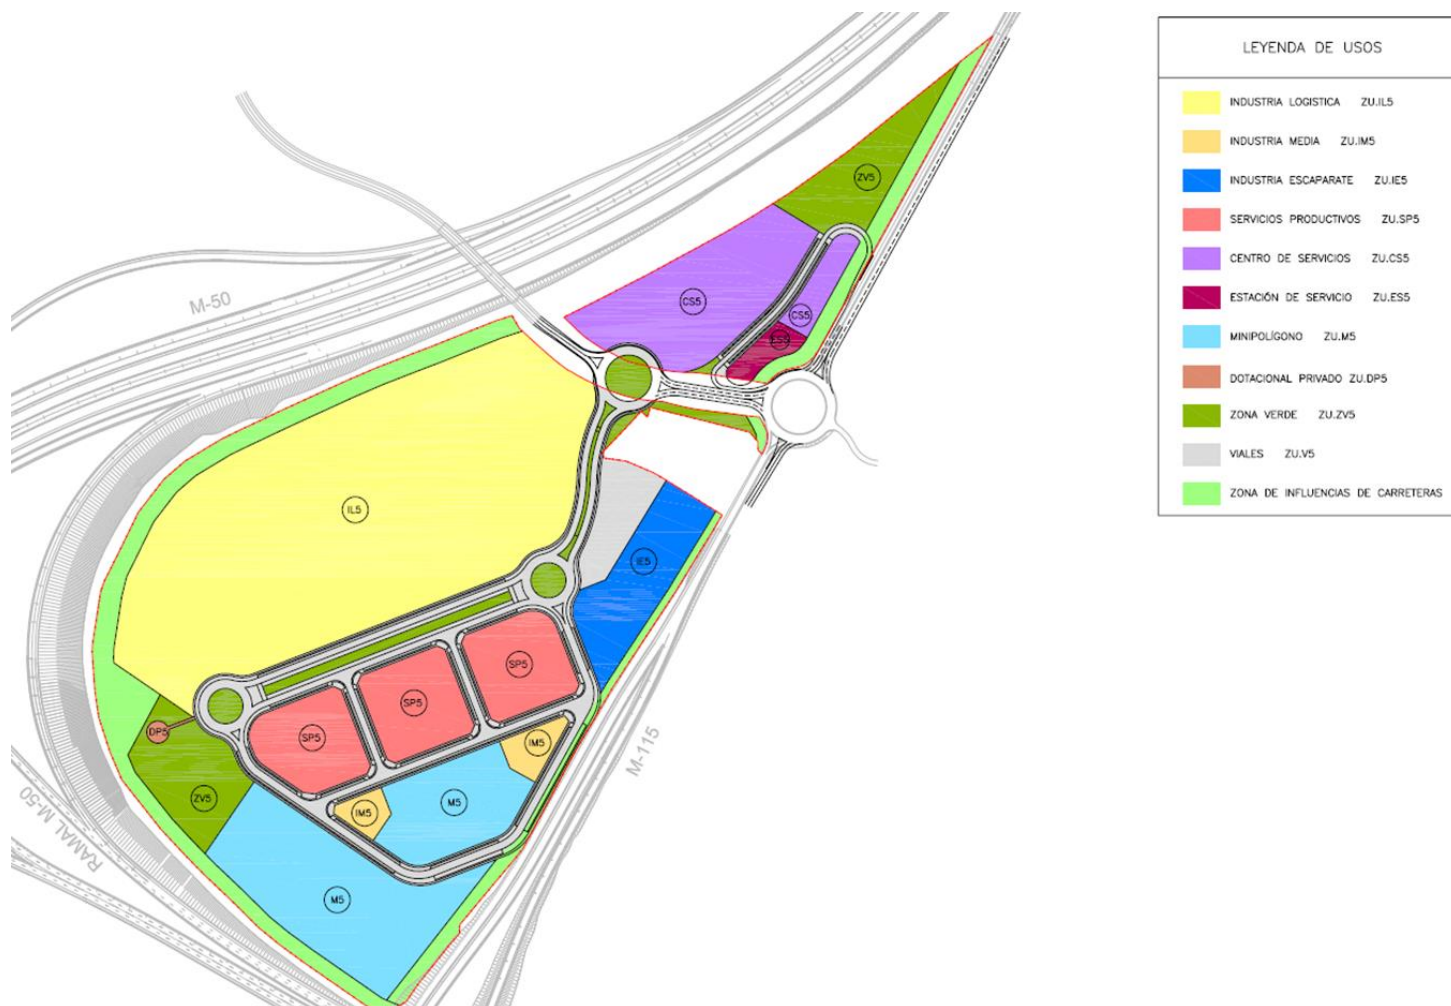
Sector SUP-15 según las modificaciones del Plan Parcial
